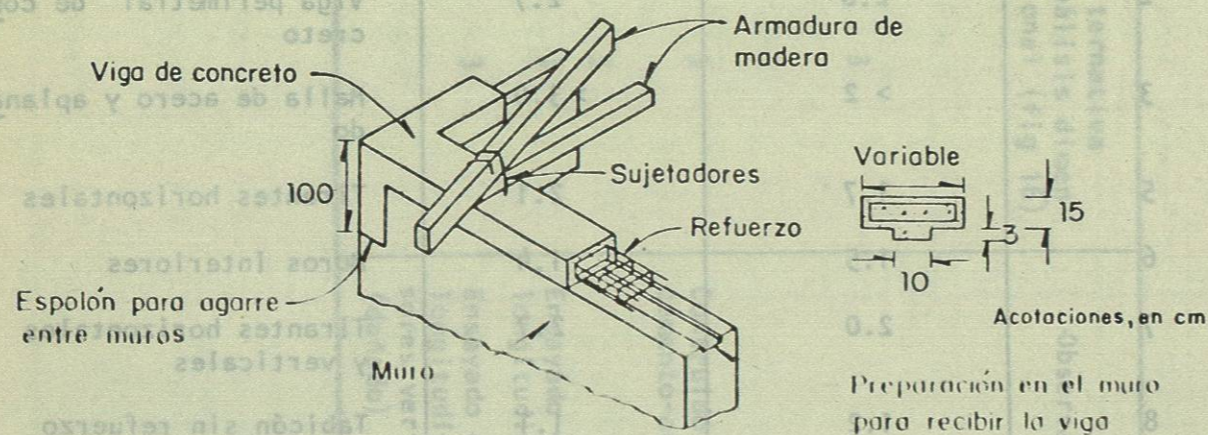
Refuerzo con viga cadena de concreto (ref 3)
